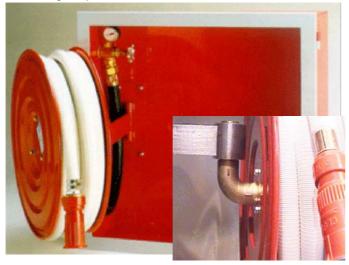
BIE de 25 mm con la devanadera desplegada. En el detalle se observa la entrada de la tubería por el eje de la devanadera
